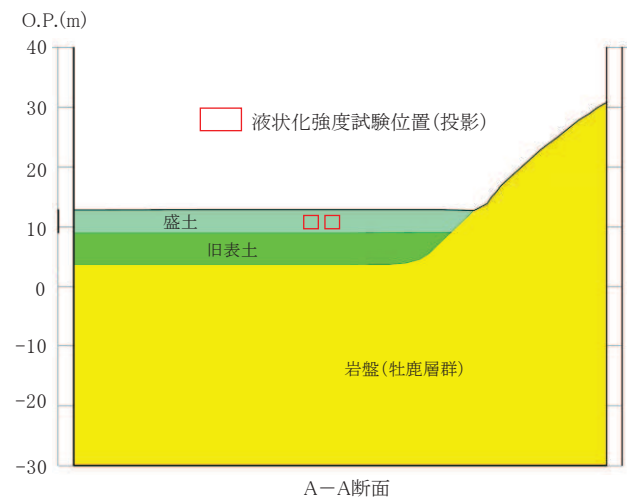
(2) 盛土の液状化強度試験に用いる試料採取位置断面図(2/3)
